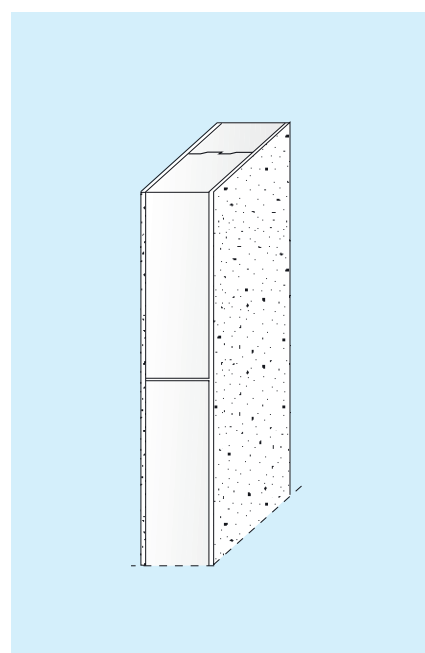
Verputztes KS-Mauerwerk ohne Wärmedämmung
